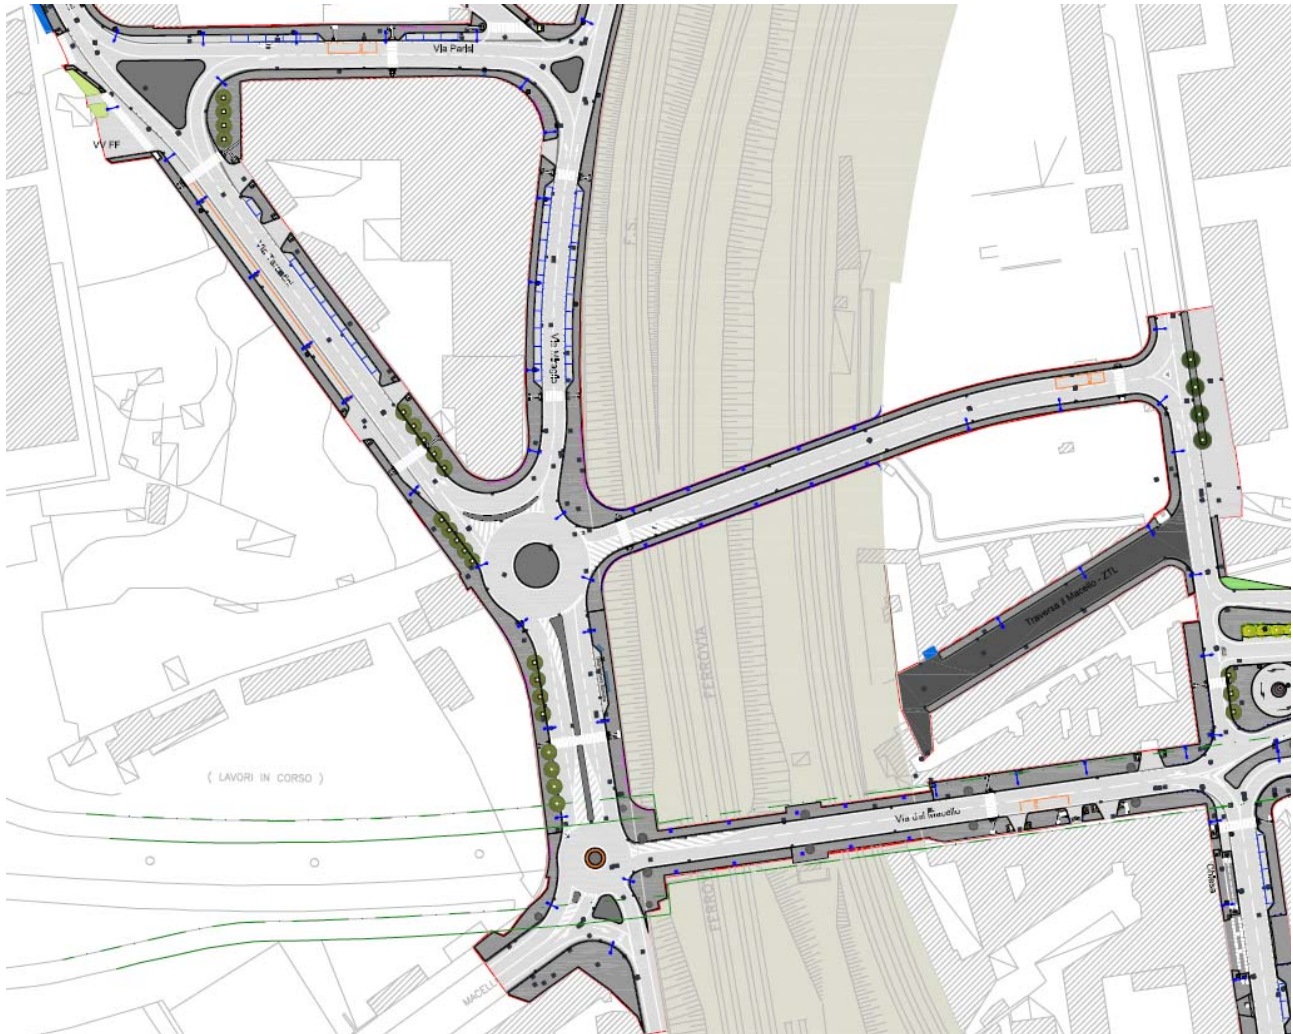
Individuazione planimetrica nuovo asse viario di collegamento tra via Traccia Poggioreale e via Miraglia con attraversamento ferroviario di progetto
